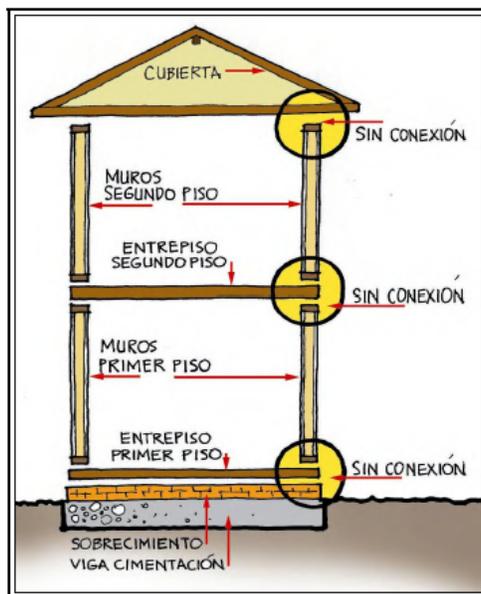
Detalle de malas conexiones entre miembros estructurales. Fuente: AIS, 2002
